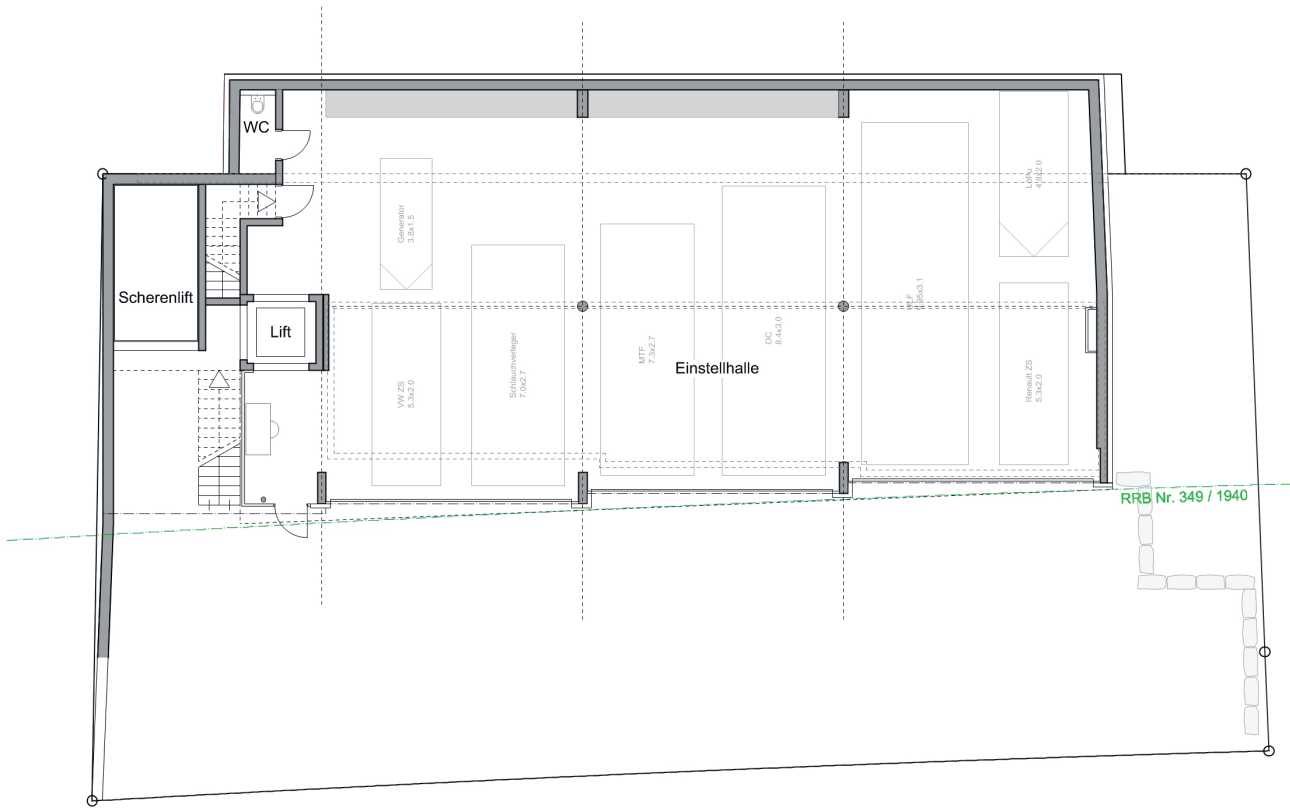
Grundriss Erdgeschoss (Einstellhalle)
